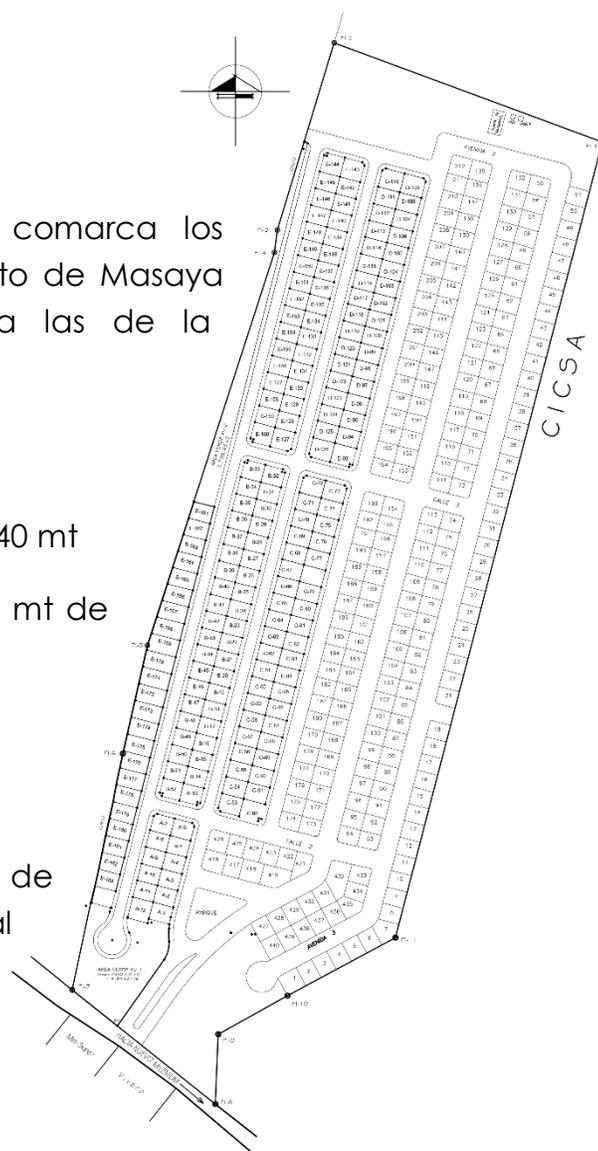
Planta de lotes urbanización "Puertas del Sol".
